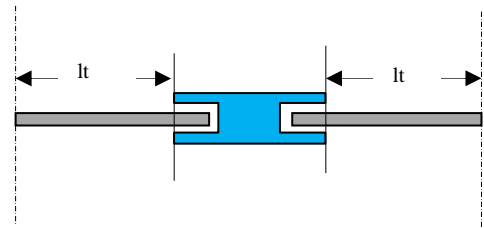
Coupe transversale au niveau du profil porteur ou profil ouvrant
